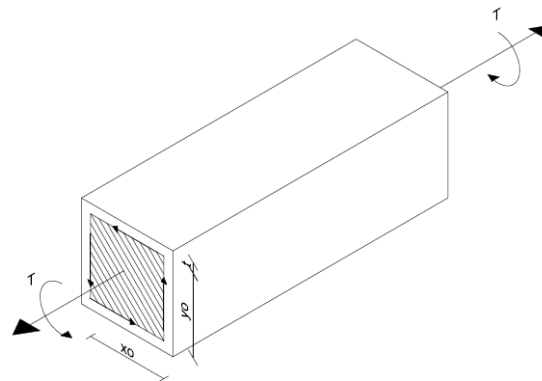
1Viga equivalente de hormigón armado.
